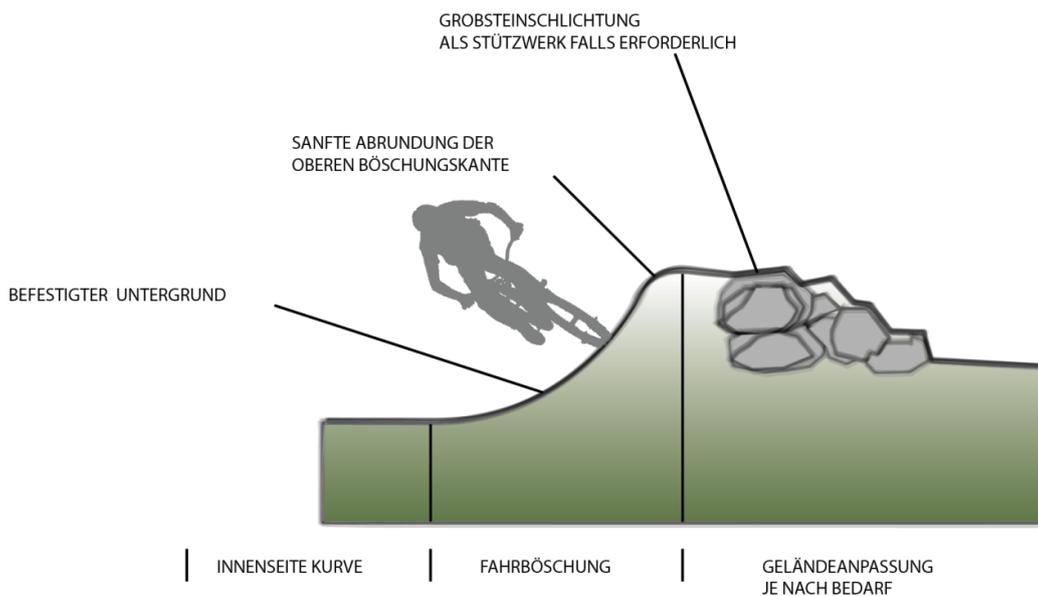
Profilschnitt einer Steilkurve in Anlehnung an die technische Zeichnung The Chainless One, ILF Consulting
